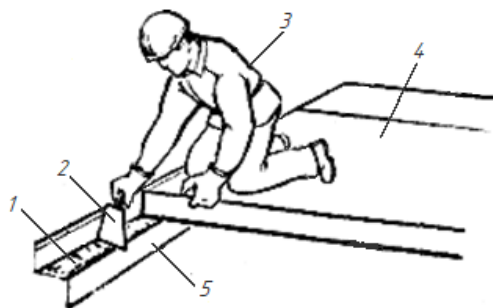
Подготовка места установки плиты перекрытия:
